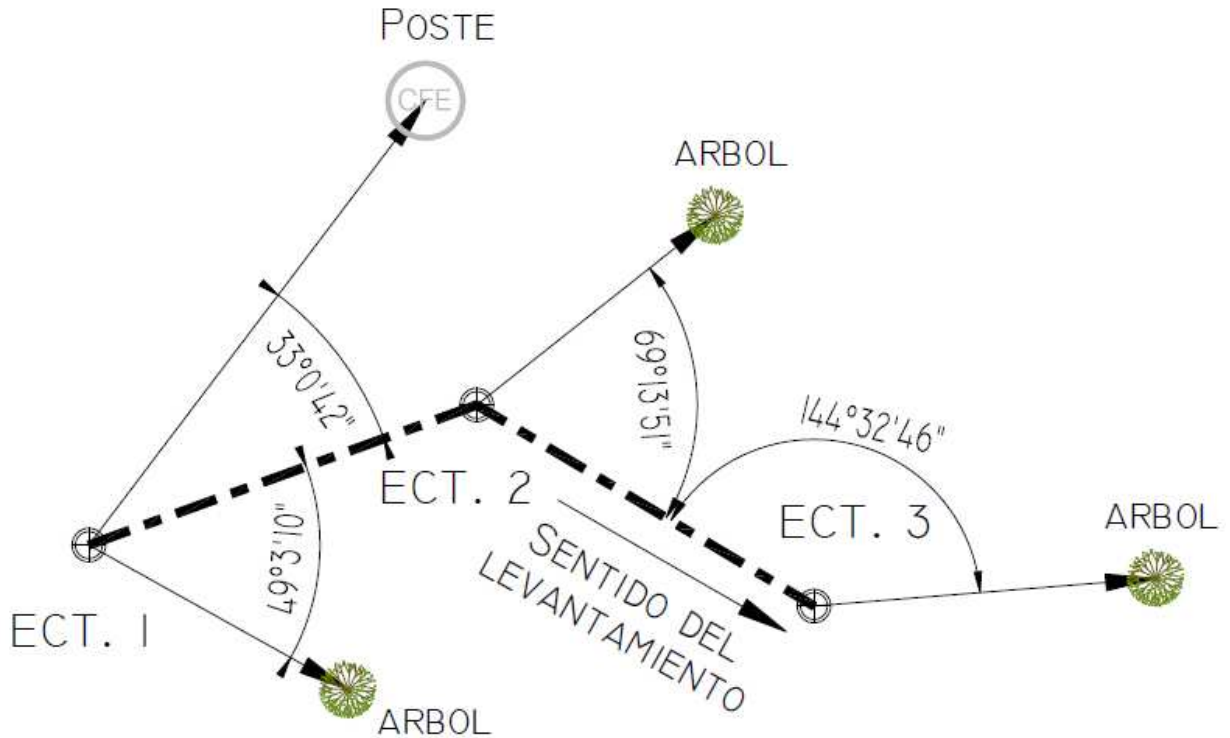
Esquema de un levantamiento con base en una poligonal de apoyo.
